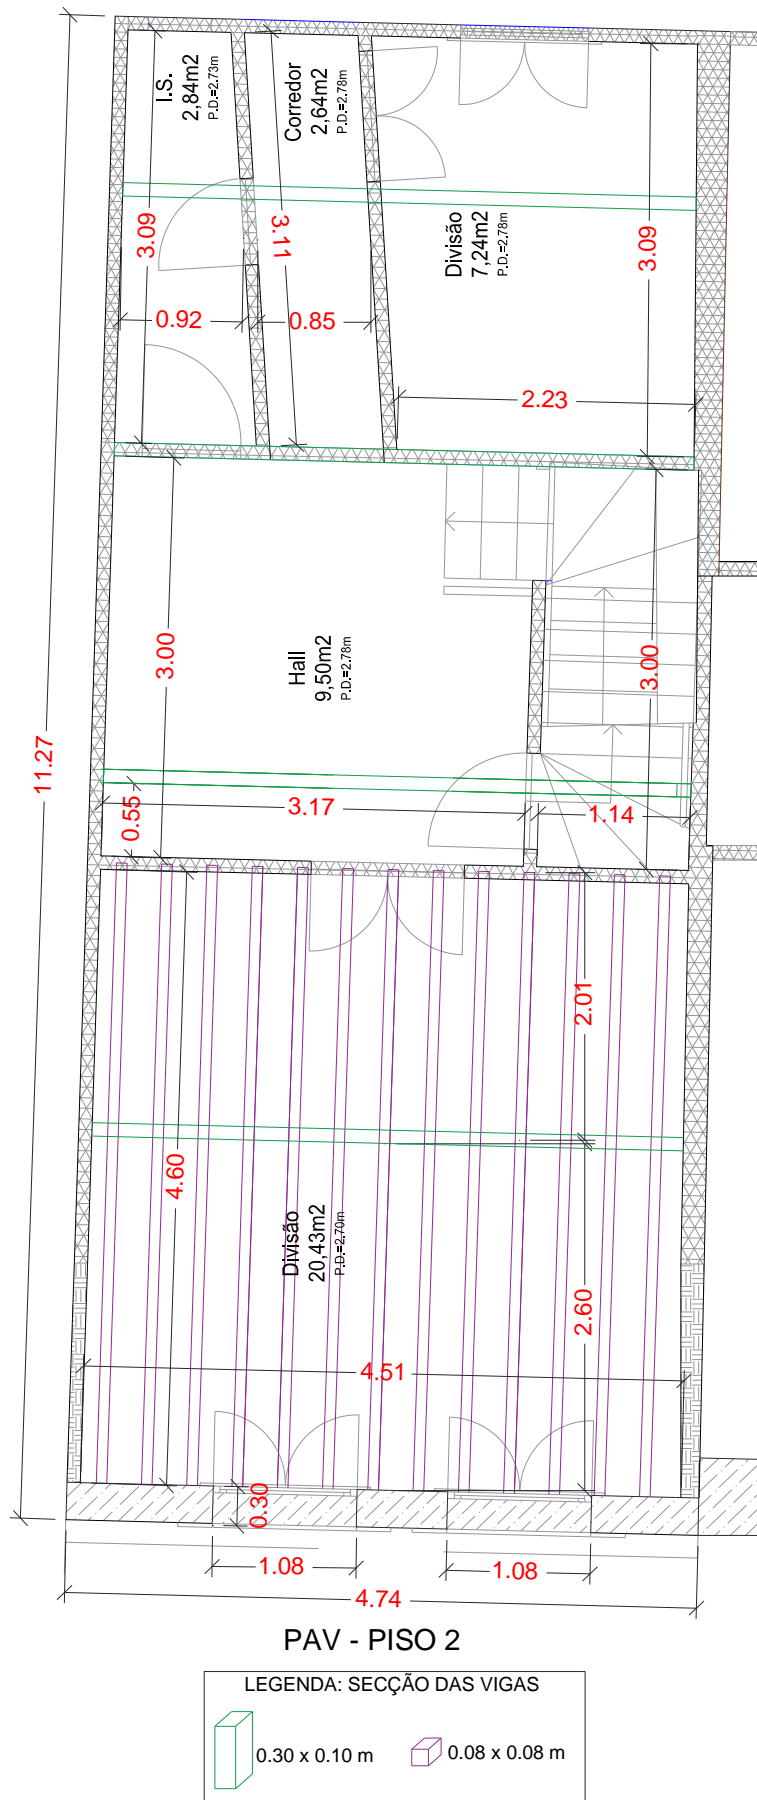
Disposição das vigas no pavimento do Piso 2
